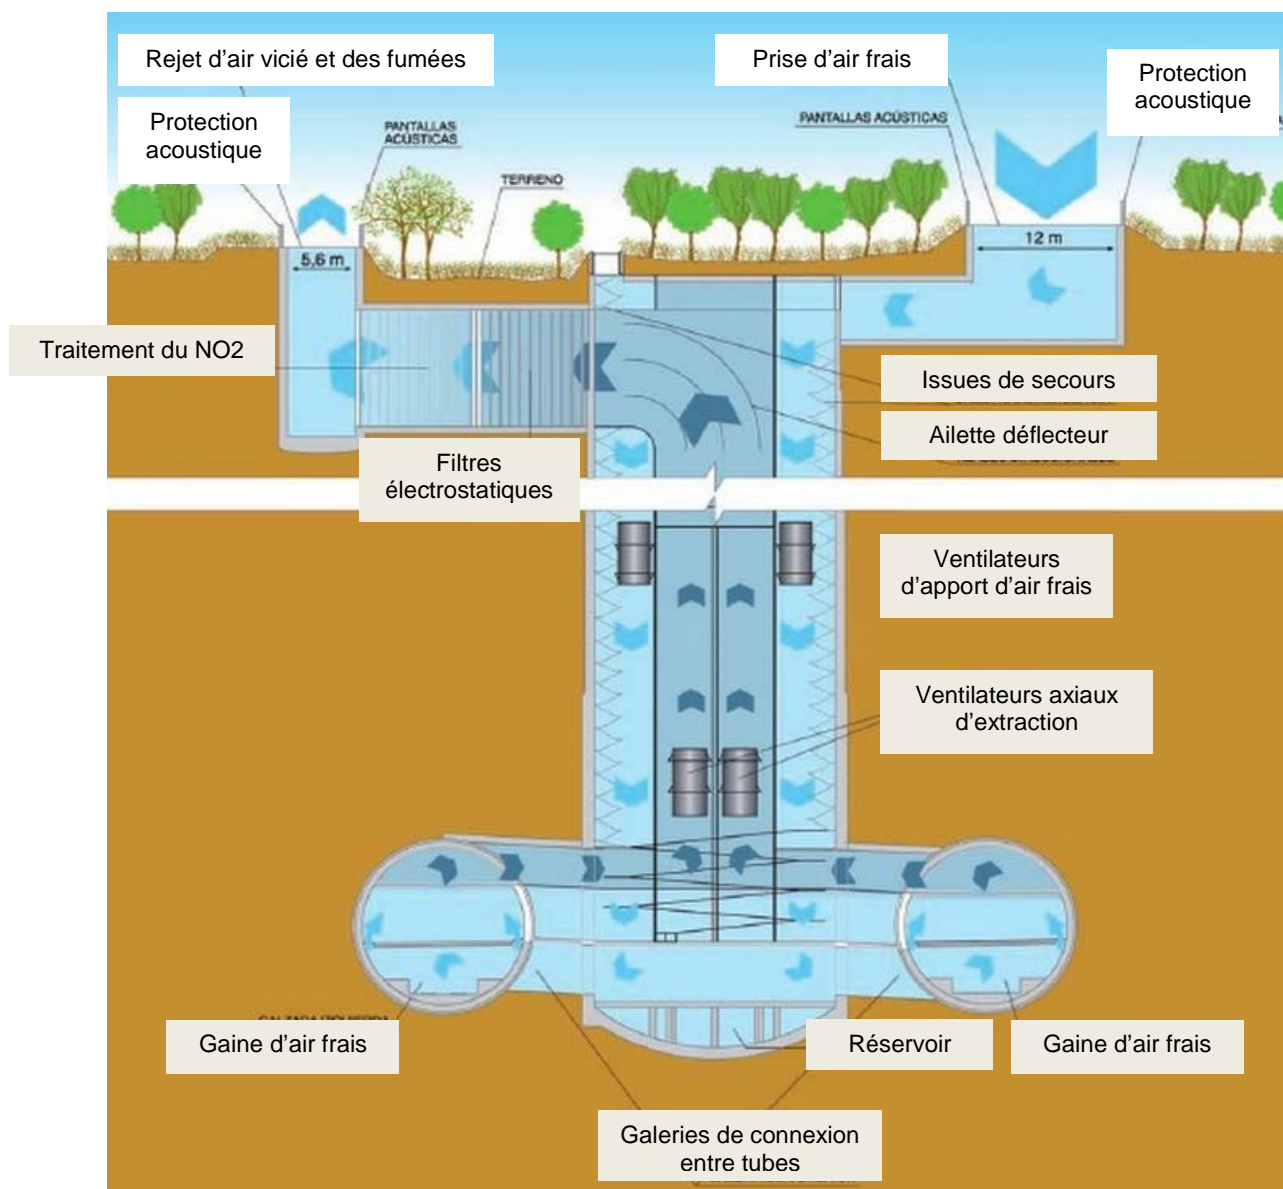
puits de ventilation du tunnel BY-PASS de la M30
